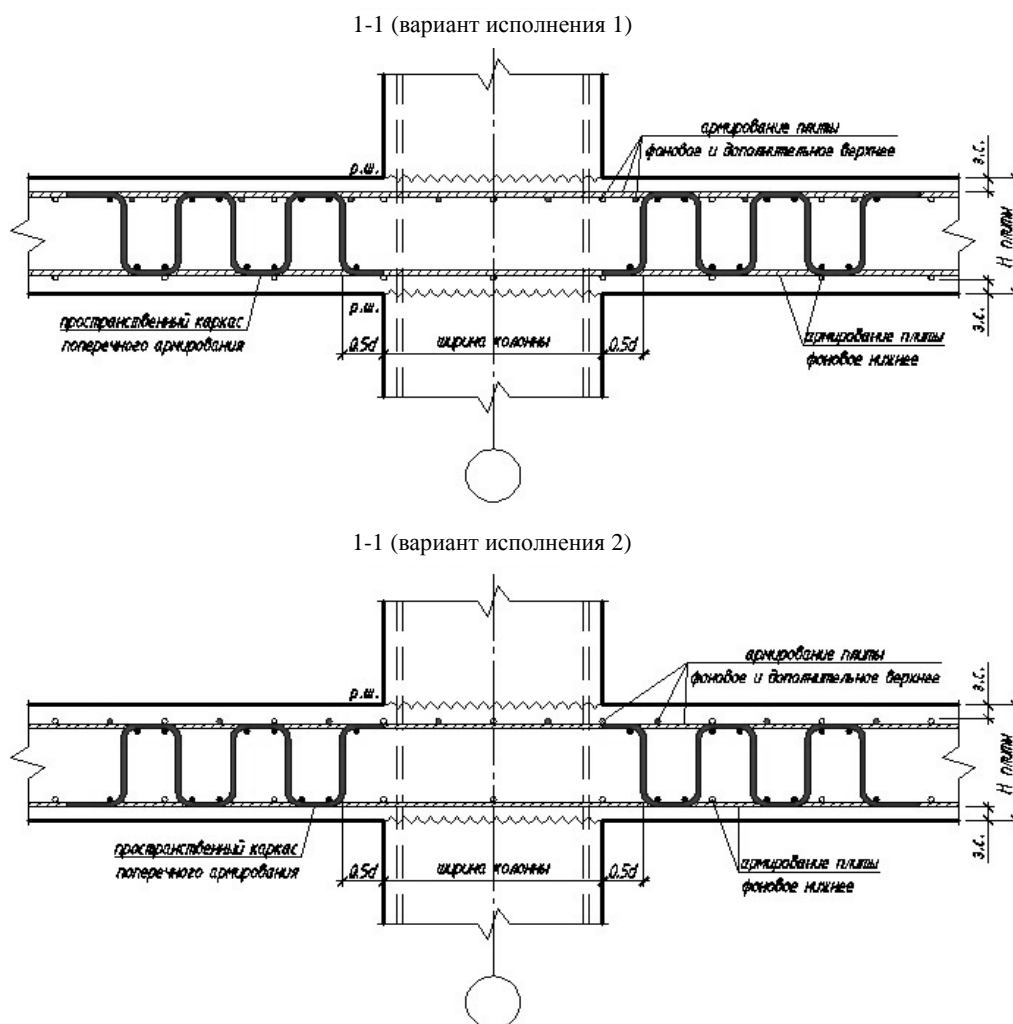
Каркасы поперечного армирования в зоне сопряжения плиты и колонны
